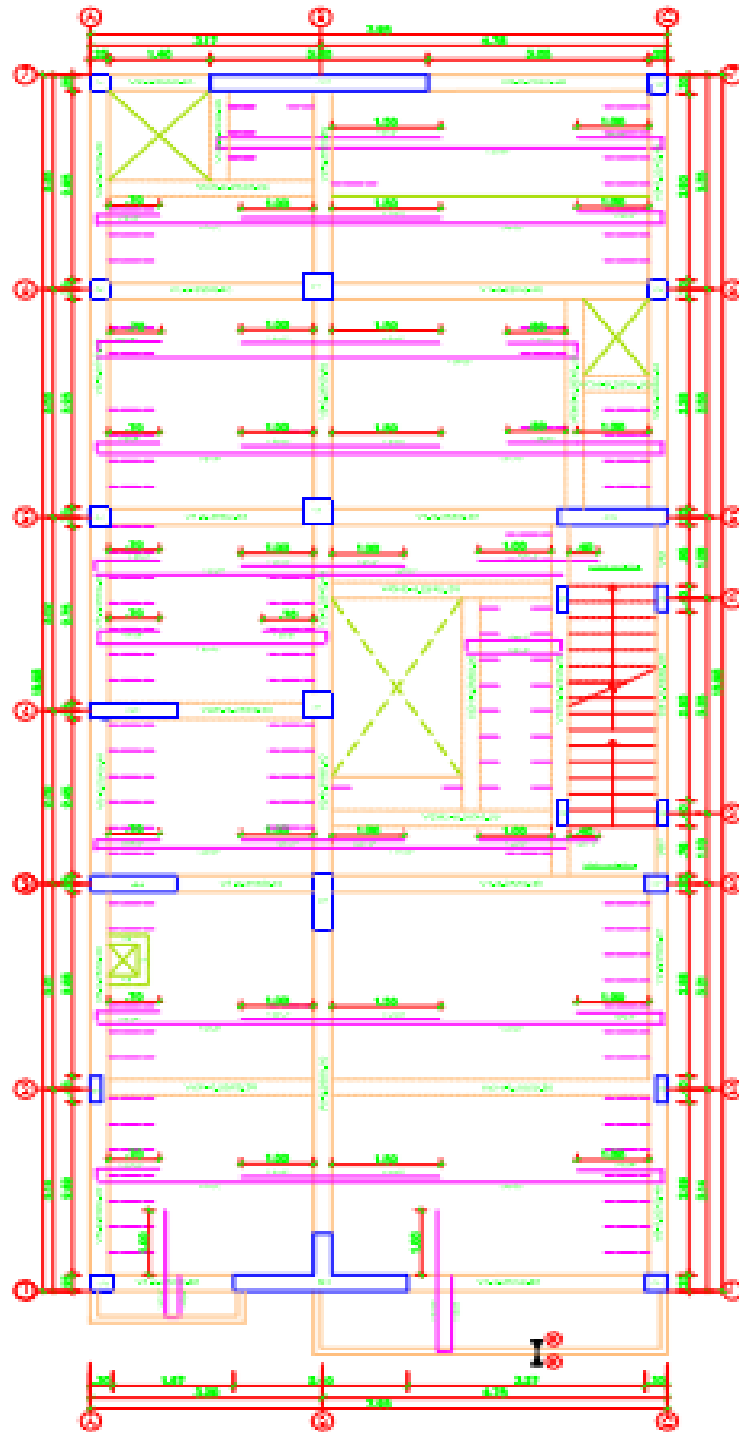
Plano de Estructura (Aligerado de 1ero a 6to Piso).
